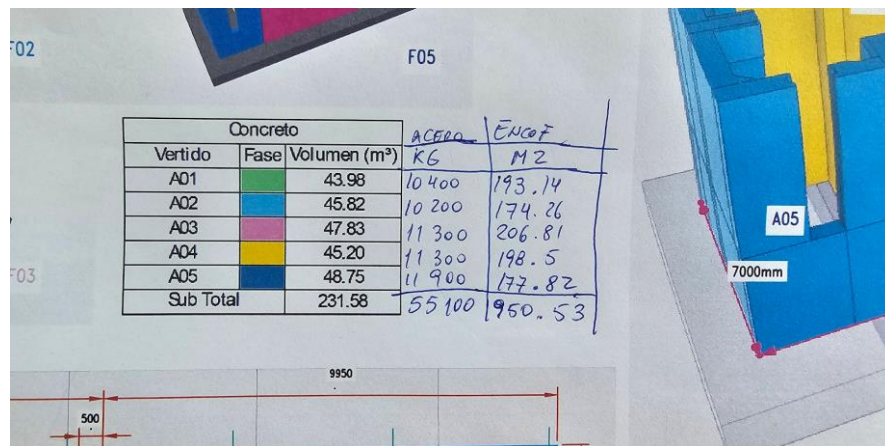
Metrado de Concreto, Acero y Encofrado del Nivel 1. TC.05
